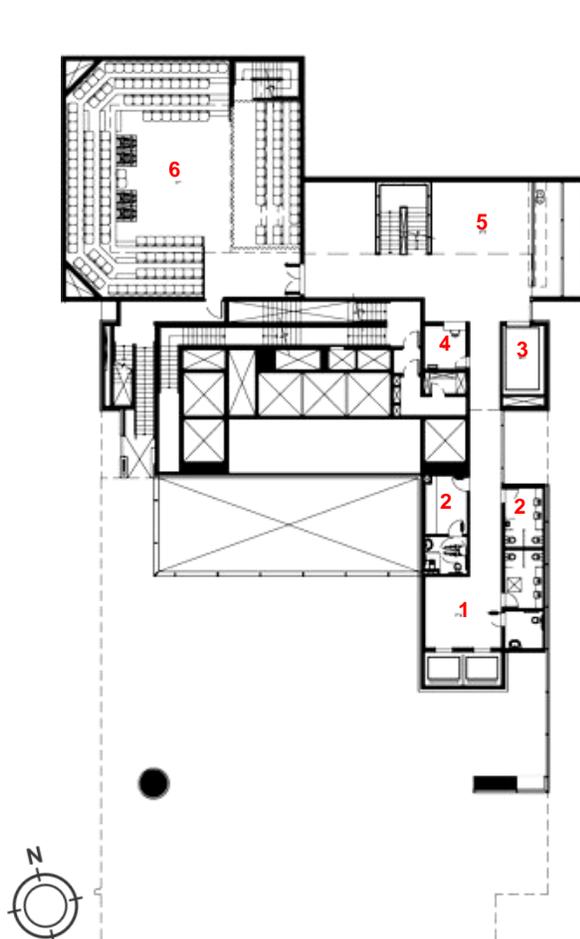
Edifício JK 1600 - Planta Baixa – Mezanino.
